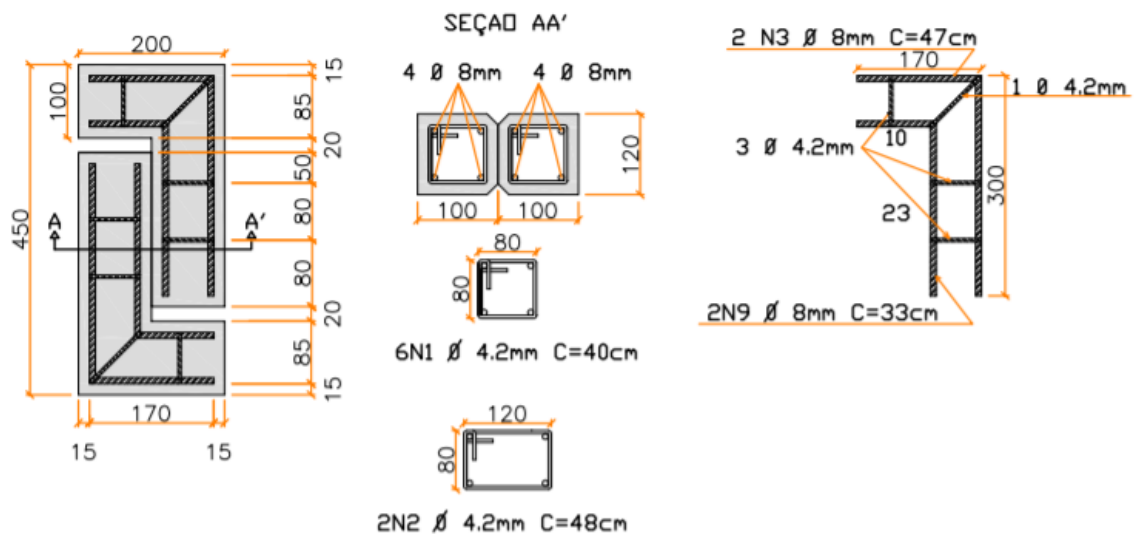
Detalhamento dos corpos de prova sem estribos.
